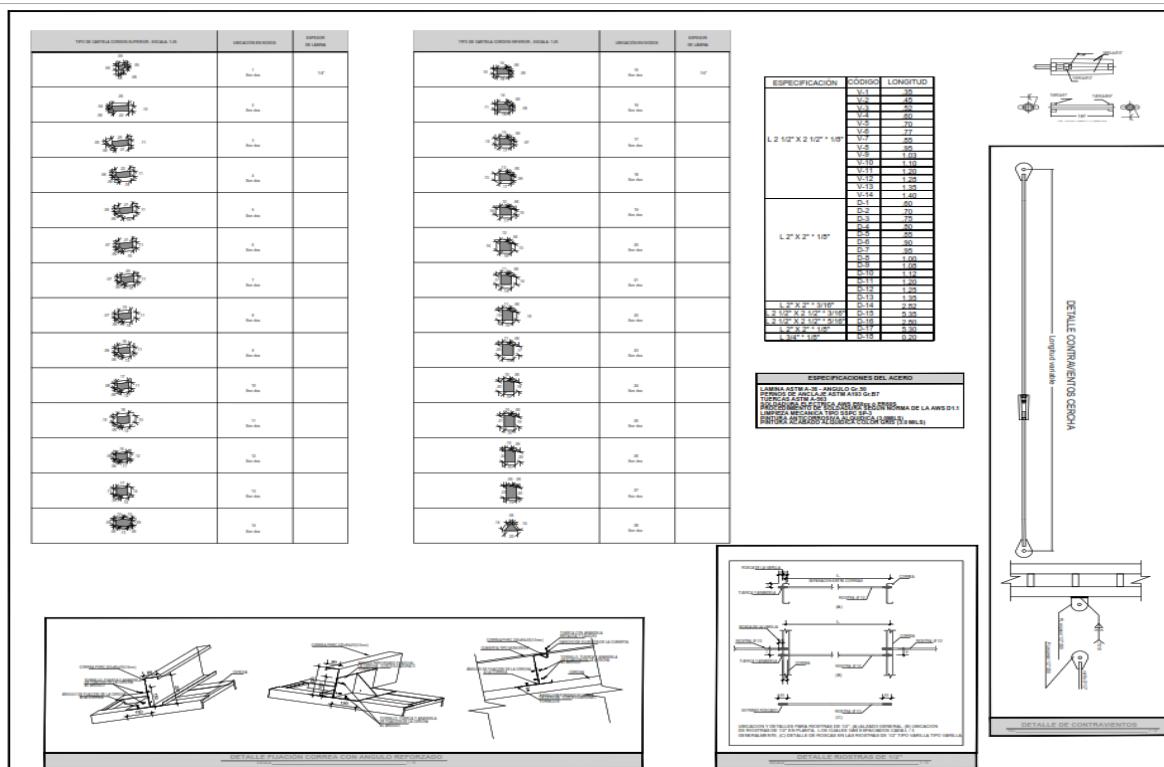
Diseño Estructural de Cubierta a Instalar
